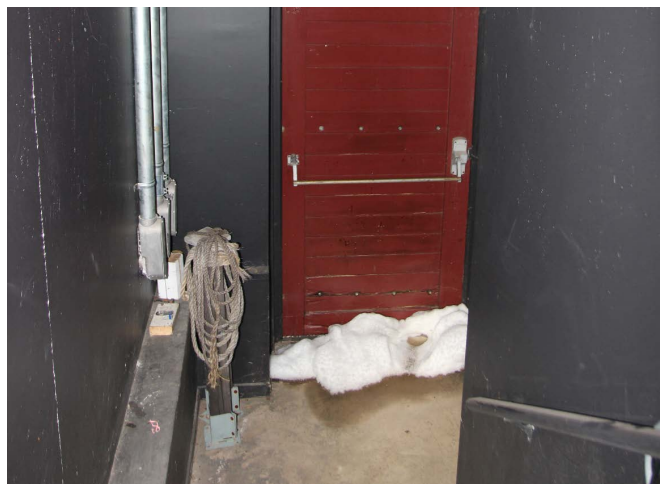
La porte n'est pas étanche et laisse entrer la neige.
